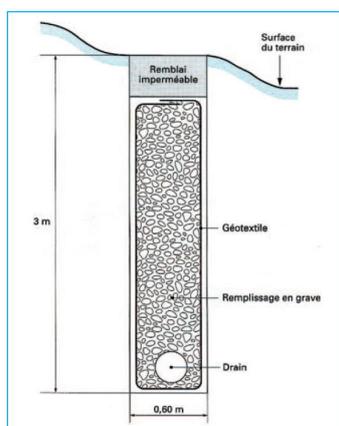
Coupe-type d'une tranchée drainante (Reiffsteck, [19])
